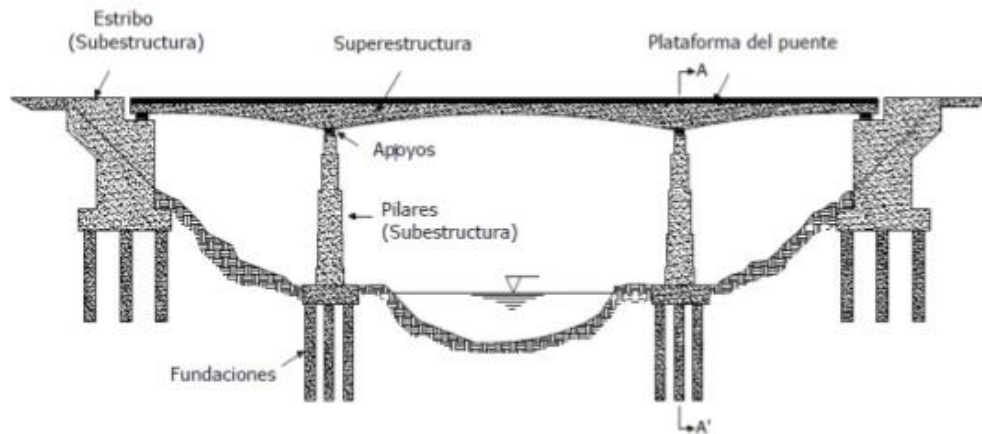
Componentes de un puente, vista longitudinal (Fuente Wikipedia).
